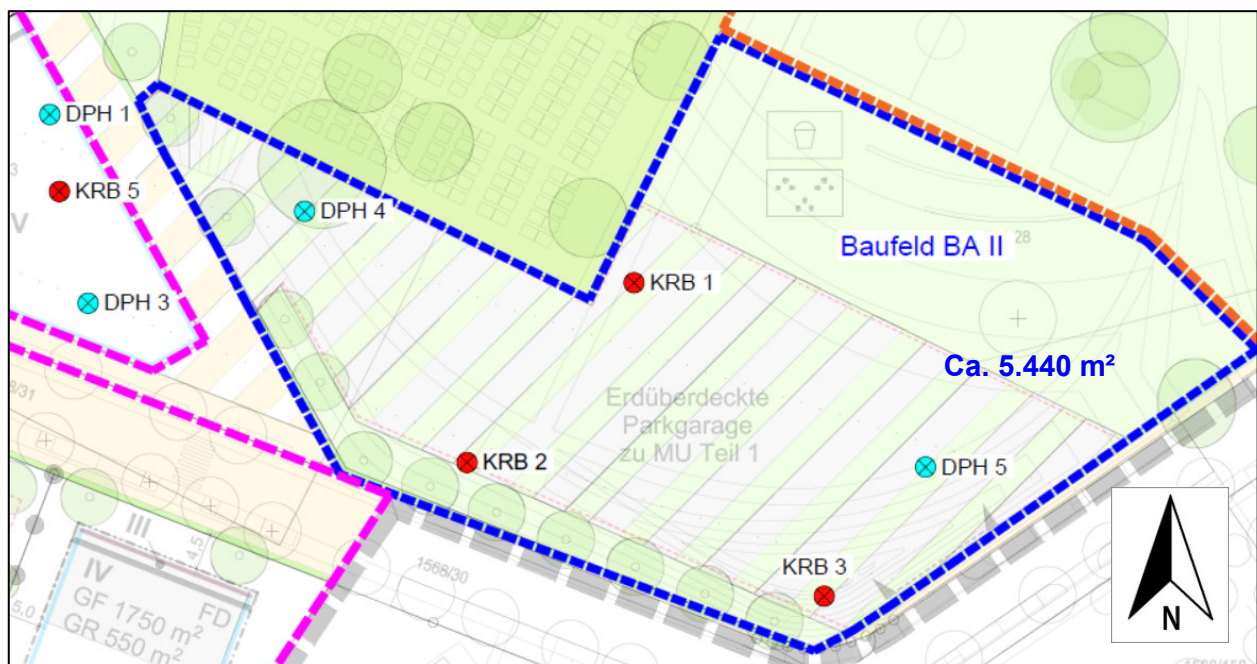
Südostteil Planungsbereich, Südteil Grundstück Fl.-Nr. 1568/28 und Ostteil Grundstück Fl.-Nr. 1568/3, geplanter Bau einer Parkgarage mit Spielplatz (Ausschnitt, Quelle /7/). Blau umgrenzt ist die Fläche der Parkgarage mit umgebender Fläche der Geländemodellierung (Rodelhügel, Rutschbahn, Sitzstufen). Kein spezifischer Maßstab; maßstäblich siehe Anlage 1.3..
